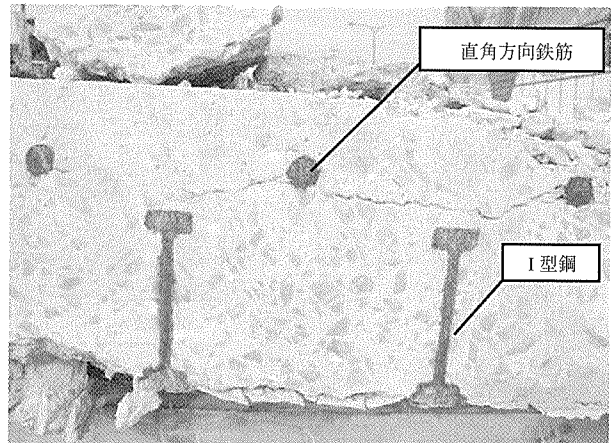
撤去床版の損傷状況 (橋軸方向断面)
